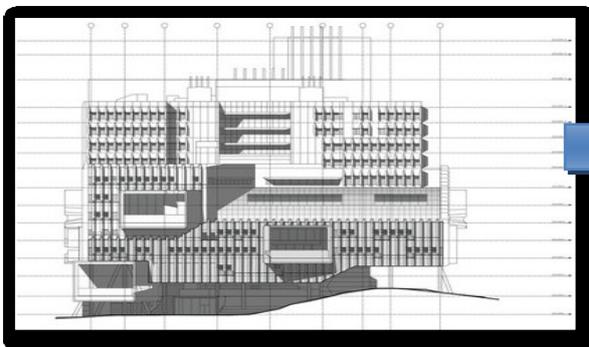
Façade latérale de l'hôpital new lady.⁵³
